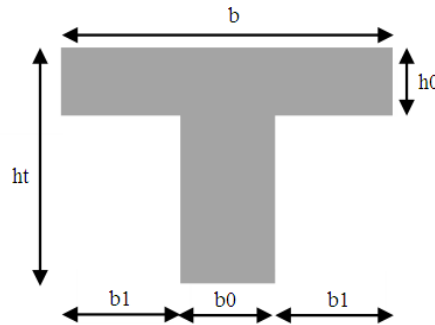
Coupe transversale d'une poutrelle.
